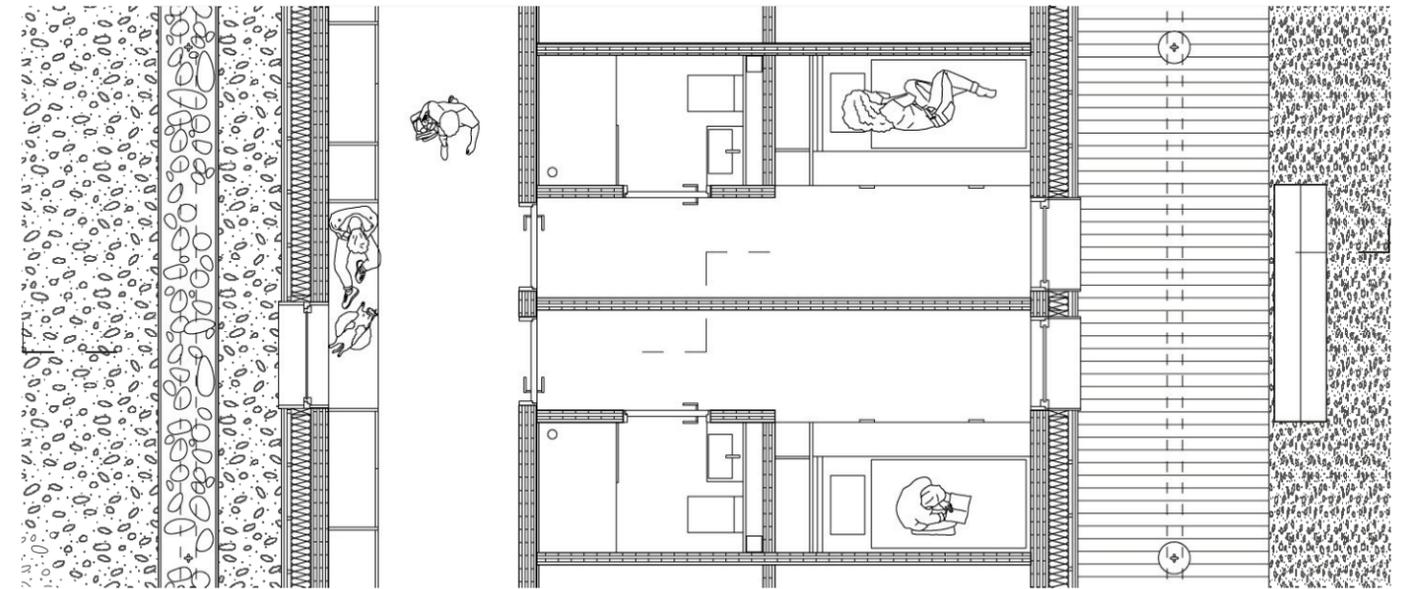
Grundriss Zimmer EG M 1:75
